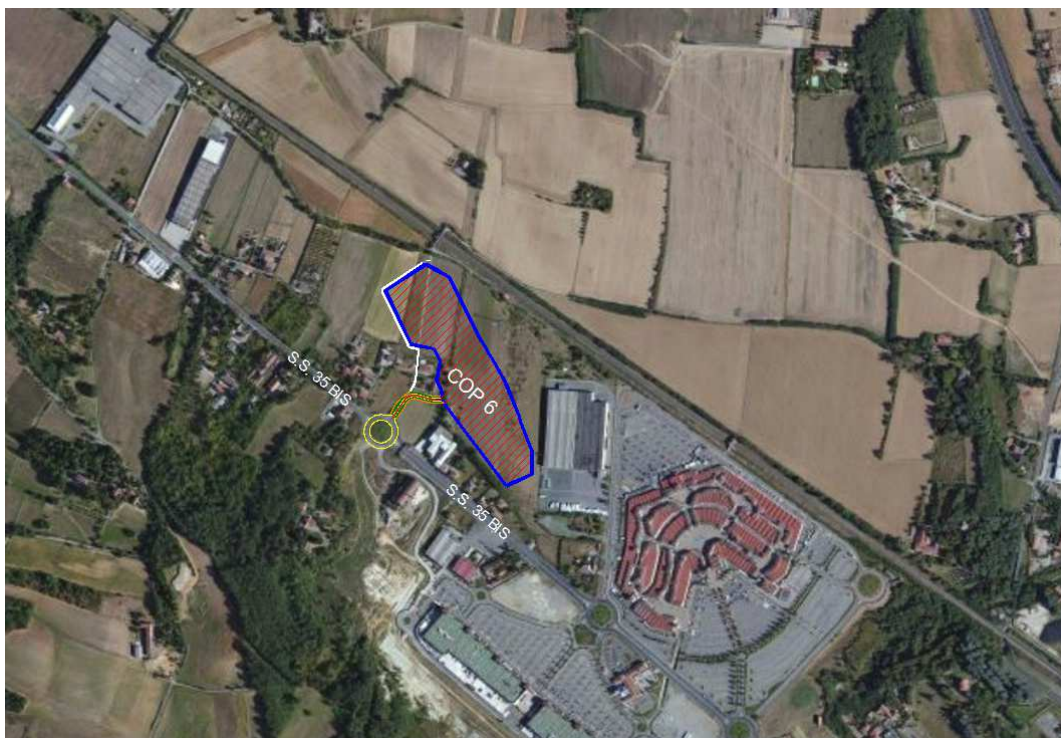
Fotografia aerea con individuazione dell'ubicazione del Cantiere C.O.P.6 per la soluzione di variante
